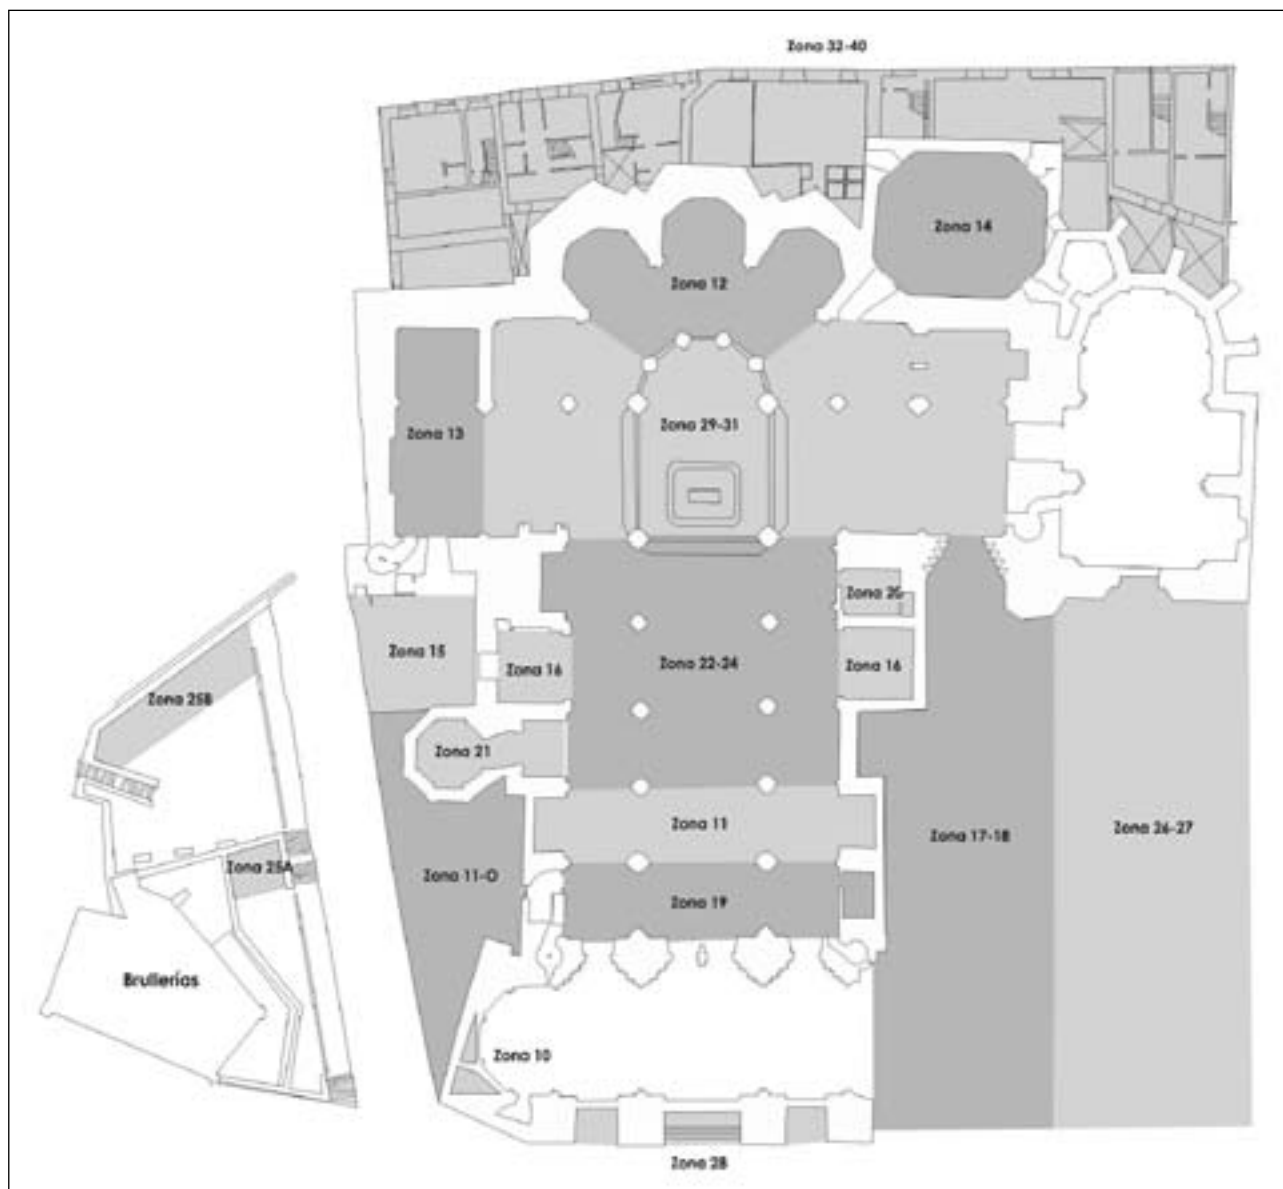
Planta de la catedral de Santa María con los sectores excavados.
